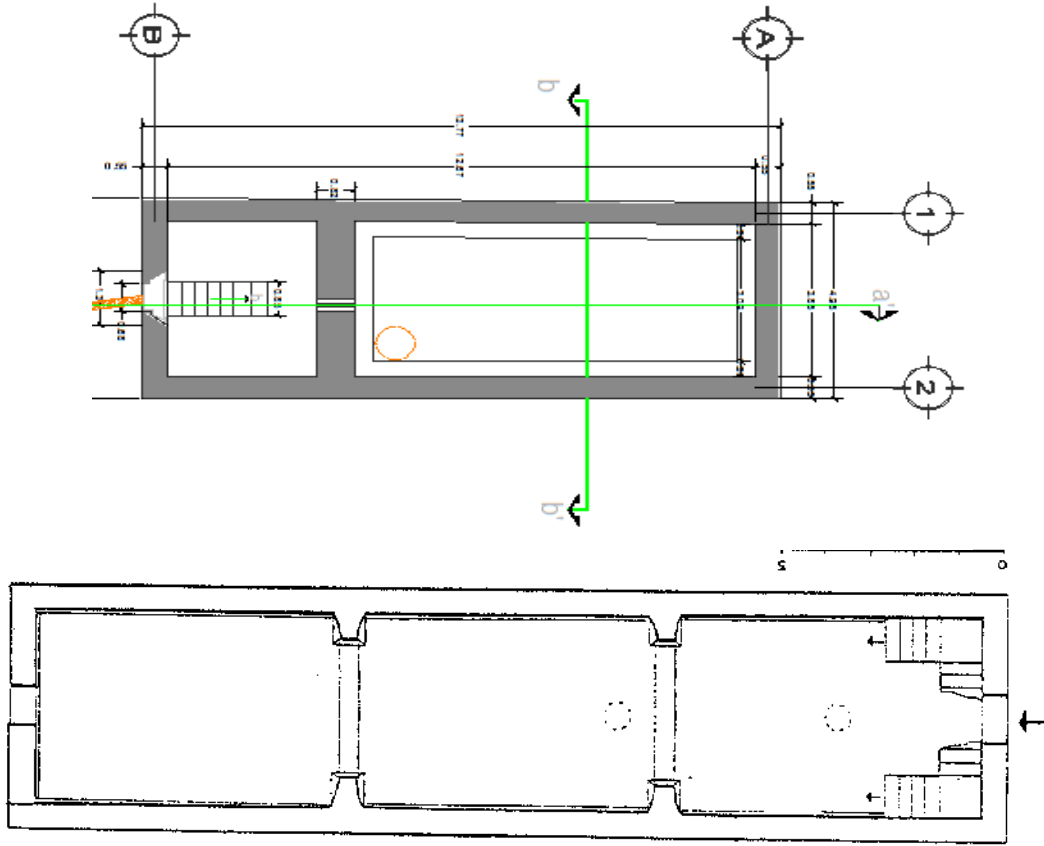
Planta rectangular. Del Aljibe de Tzintzuntzan y abajo el Aljibe de Bermejo en Nijar
